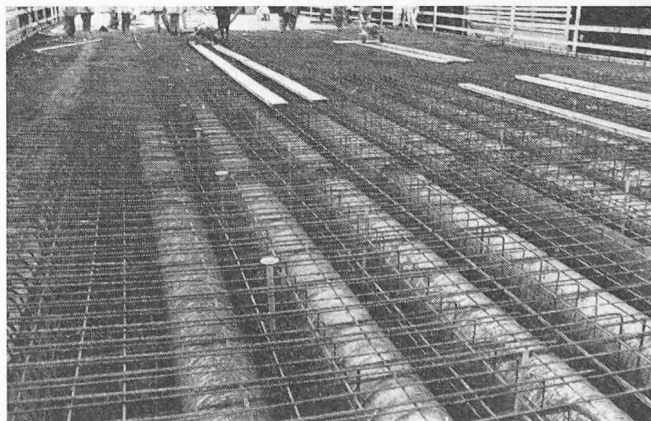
Brückenquerschnitt mit eingebauten Elementen zur Dampfdruckentspannung beziehungsweise zur Sickerwasser-Ableitung
